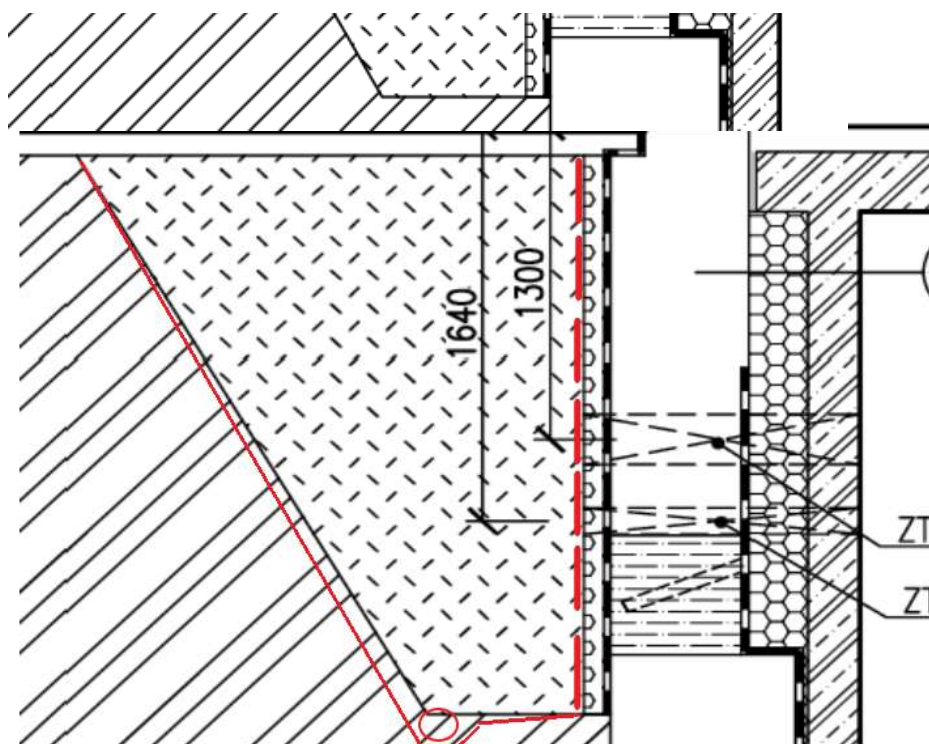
Opravený detail provedení náběhu hydroizolace
